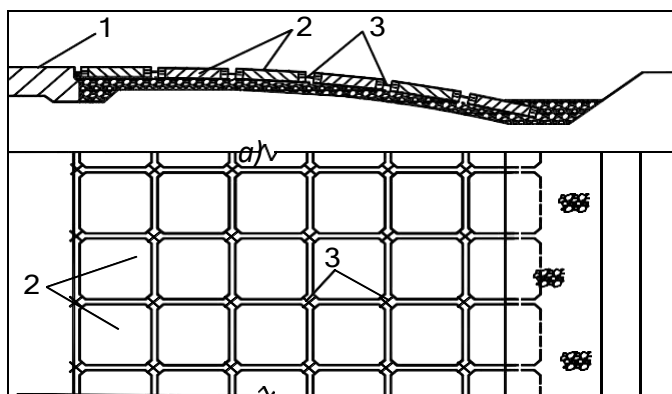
Продольный разрез и план рисбермы из сборных плит со сваркой выпусков арматуры: 1—водобой; 2 – сборные железобетонные плиты; 3 – сварка
